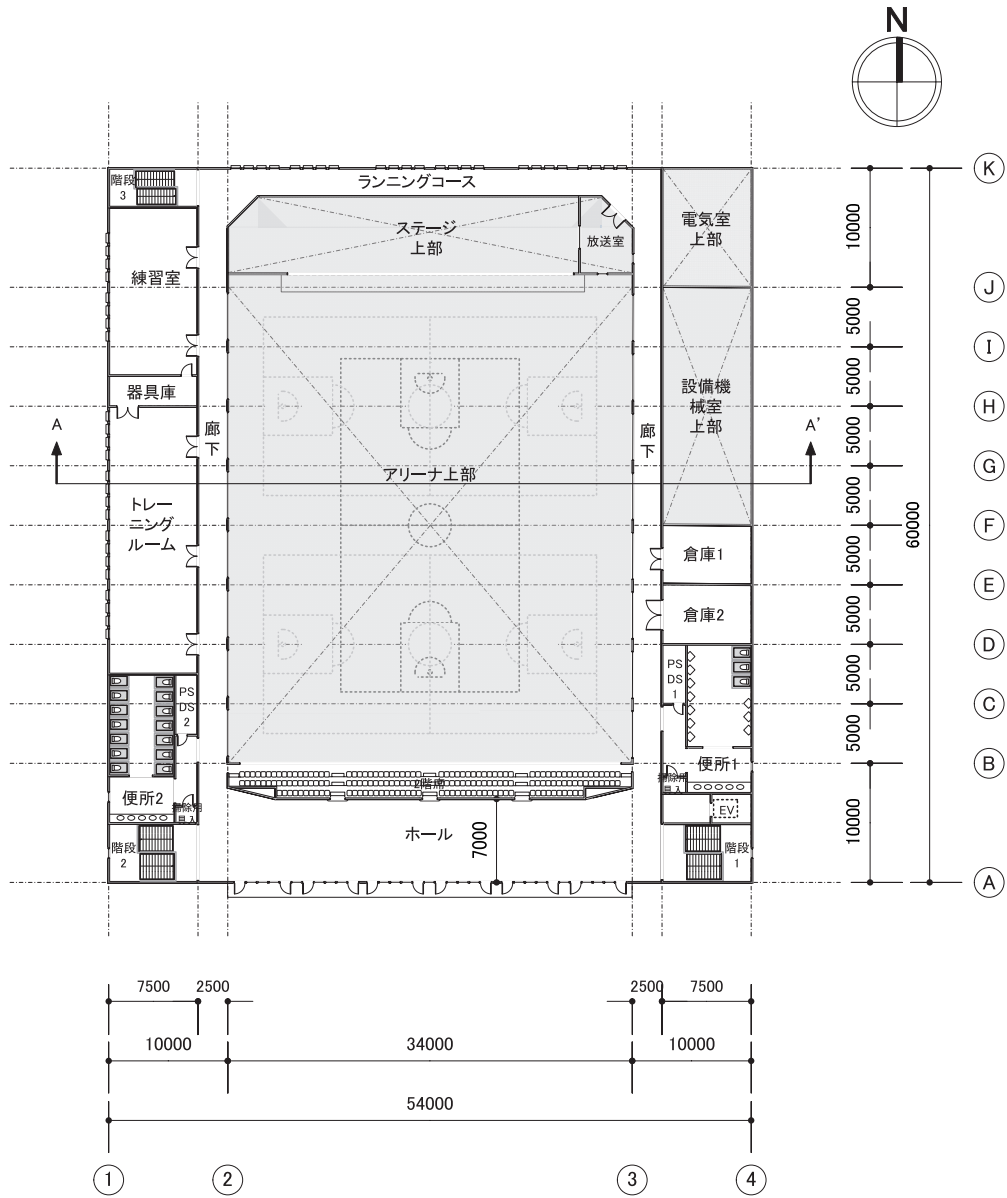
A.26 モデル建物（学校等・講堂、5,000m<sup>2</sup>） 2階平面図
